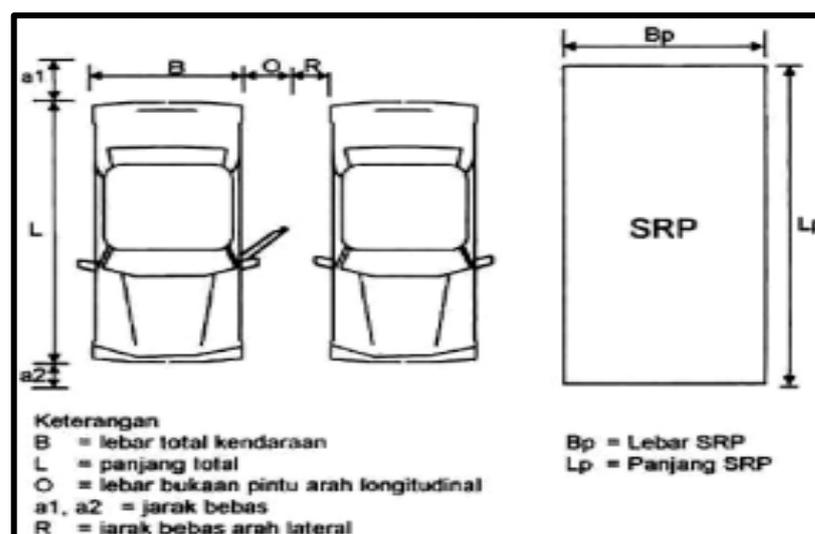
Dimensi Kendaraan Standar untuk mobil penumpang
